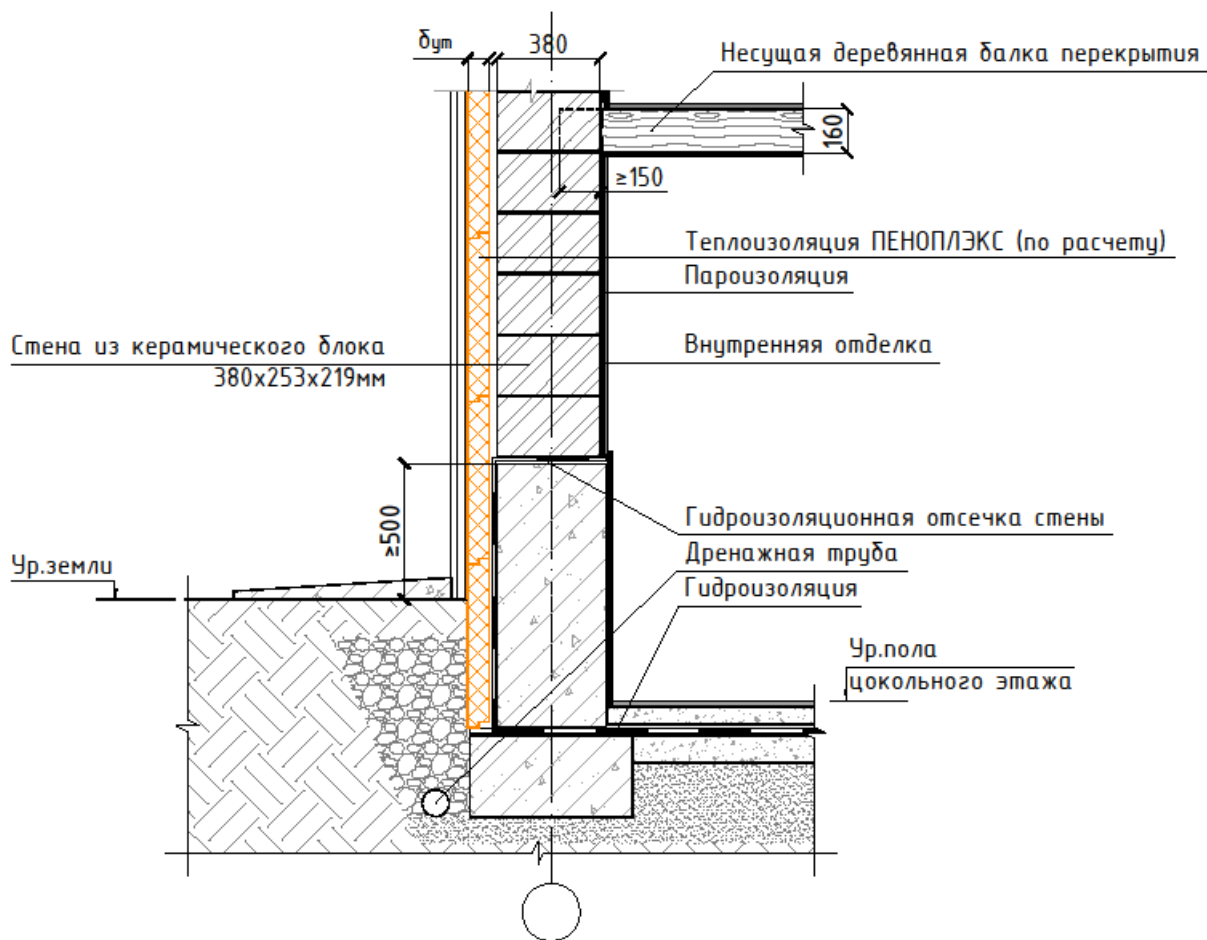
Схема сопряжения фундамента цокольного этажа и стены из керамических блоков.
